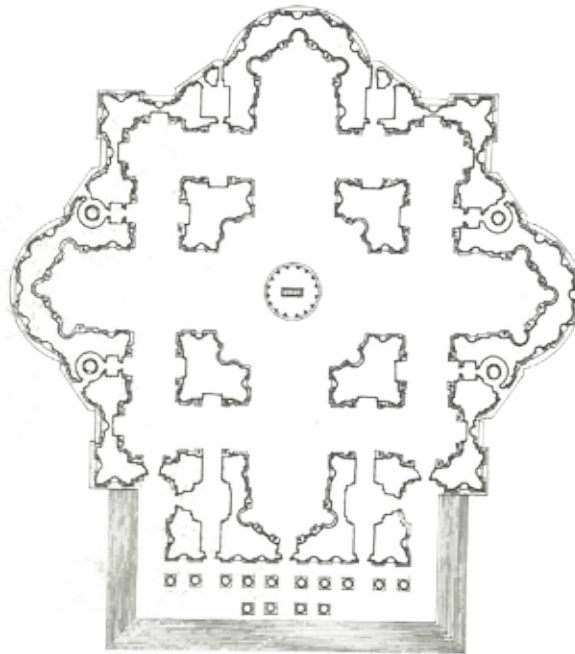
Roma, Pianta di San Pietro, progetto di Michelangelo
